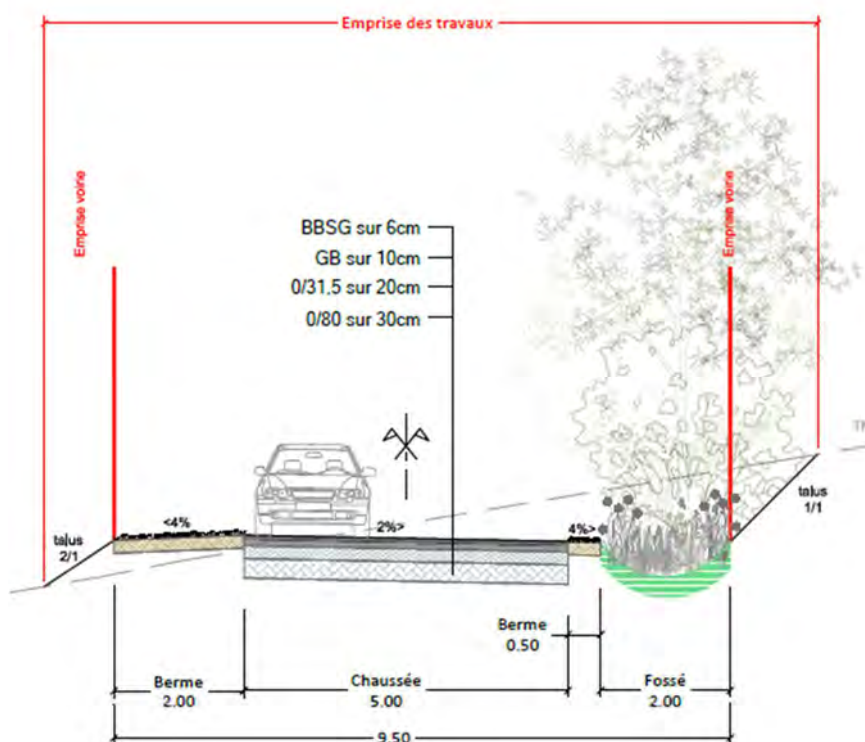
Profil en travers type de la voie F (Source: Atelier LD)
